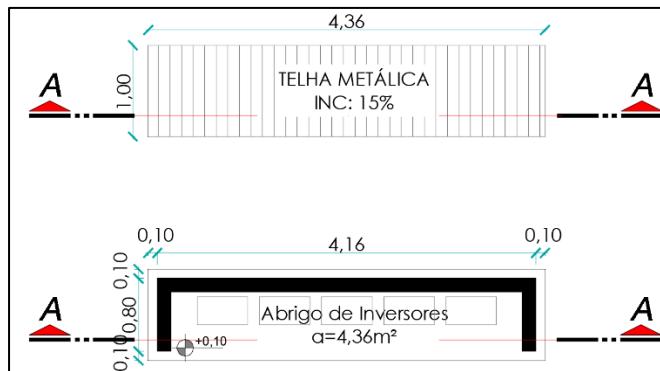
Planta baixa e detalhamentos dos abrigos de inversores.
